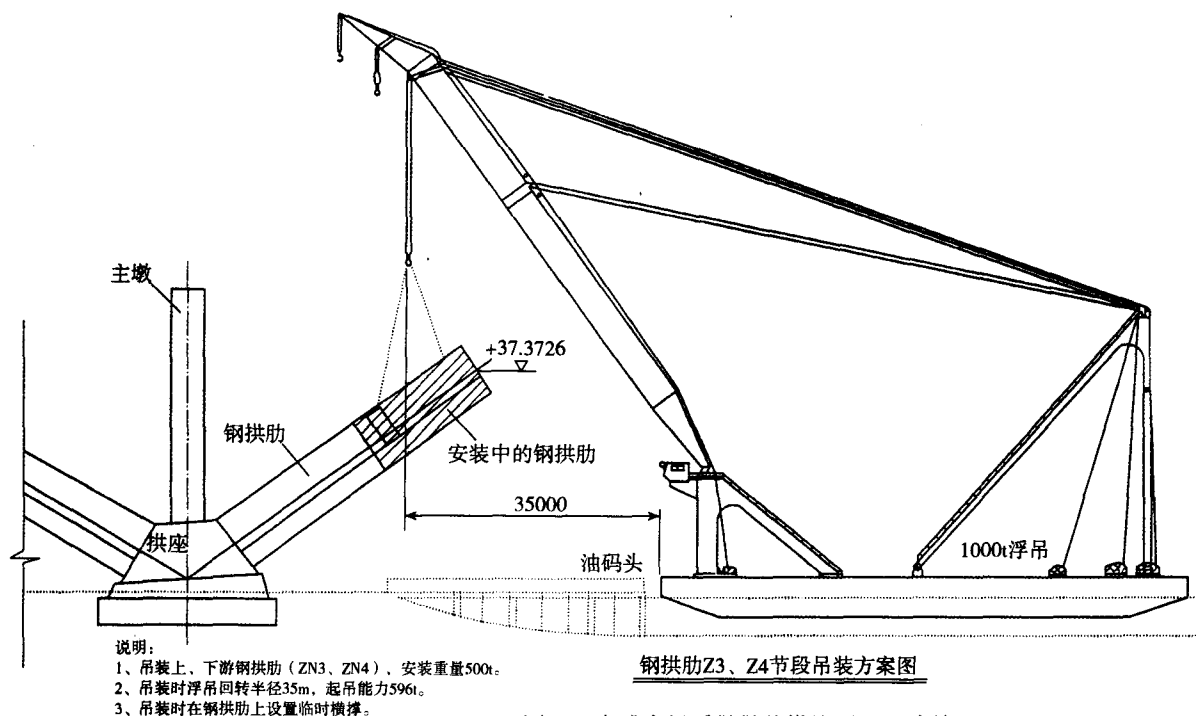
卢浦大桥浮吊吊装拱块图 (尺寸单位: mm)
